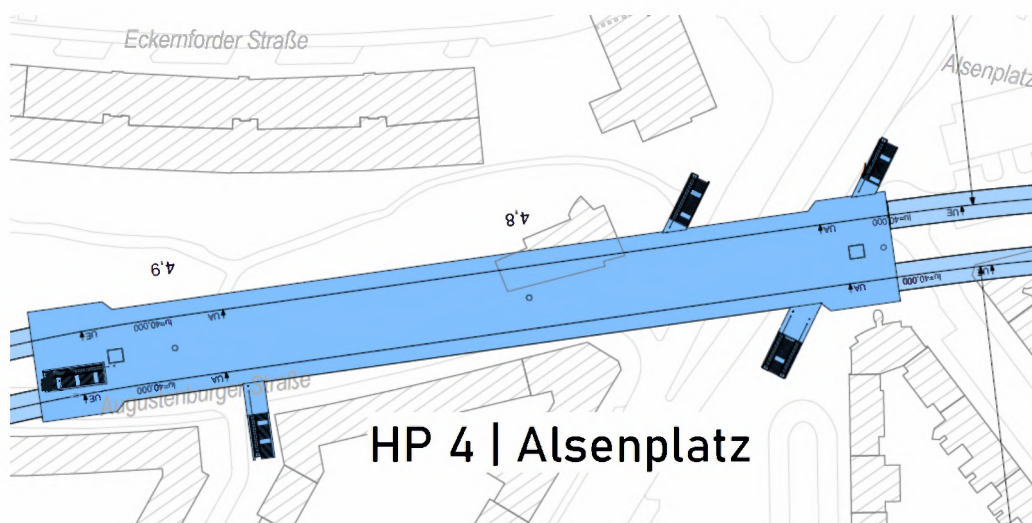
Hp Alsenplatz Var. II – Lageplan
